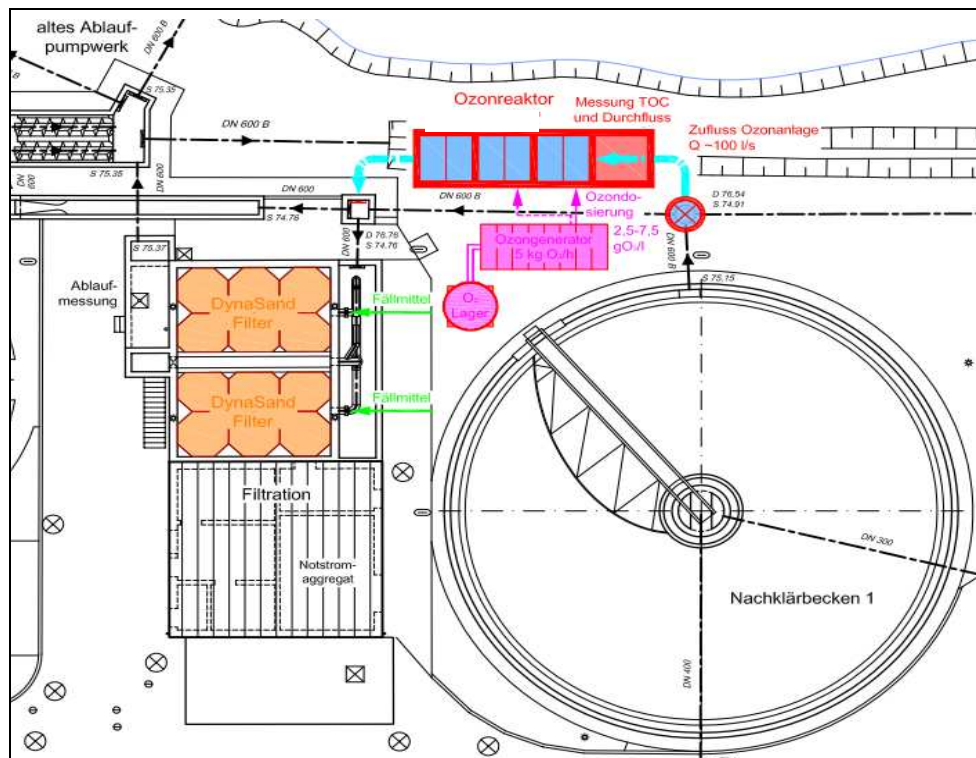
Lageplan KA Rietberg - Variante 3 – Ozonung
